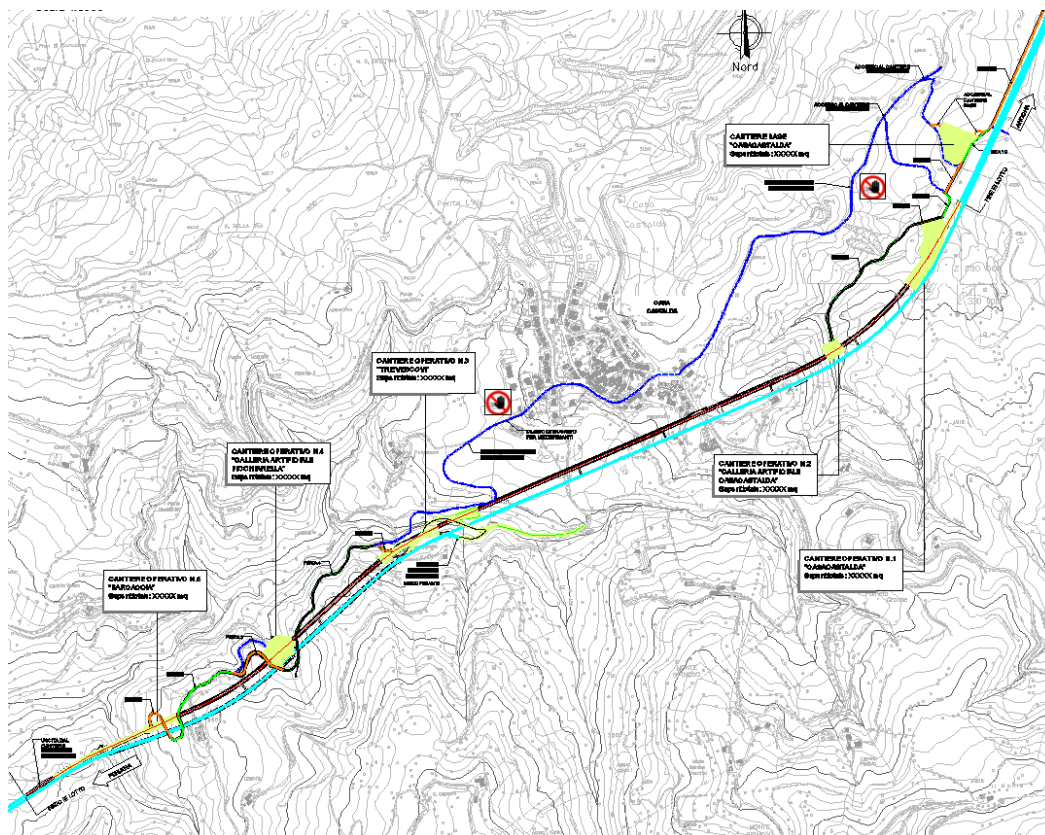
Planimetria con individuazione dei cantieri base e operativi.
